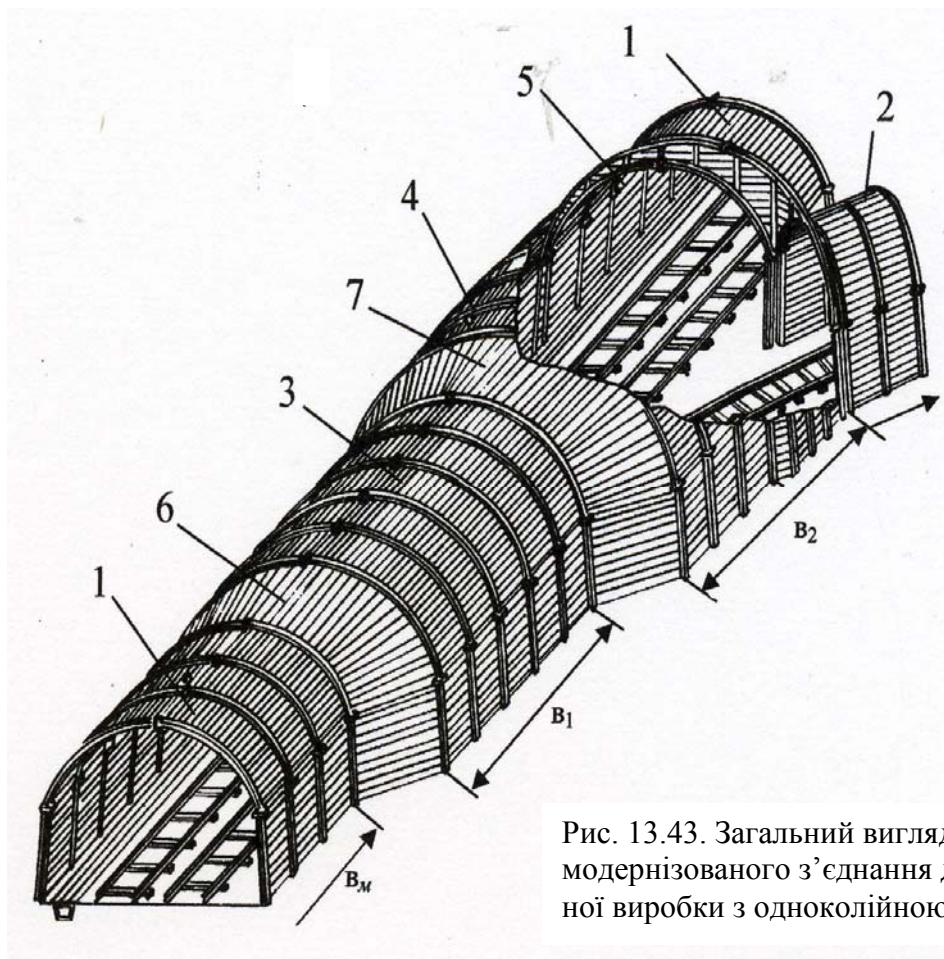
Загальний вигляд у розрізі модернізованого з'єднання двоколіїної виробки з одноколіїною
